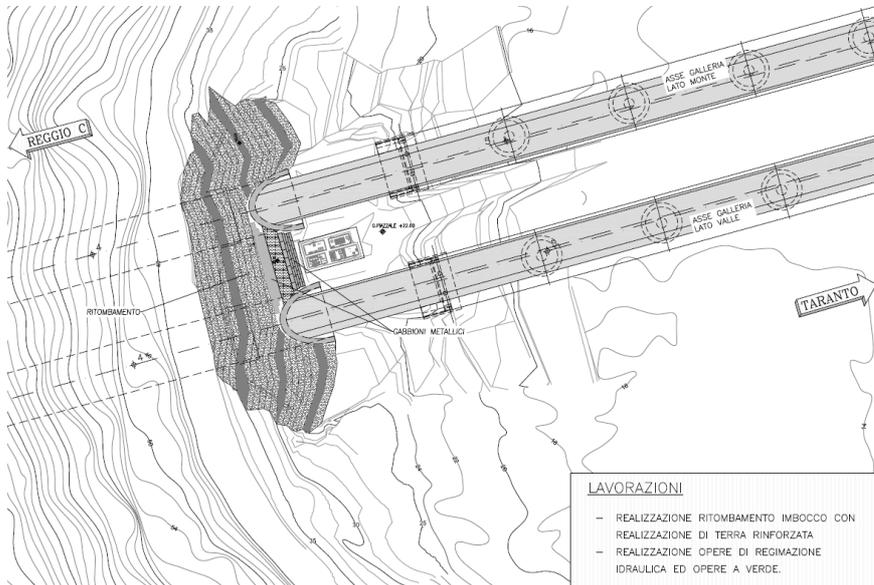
Galleria Palizzi – Fase 3 sistemazione finale – Lato TA
